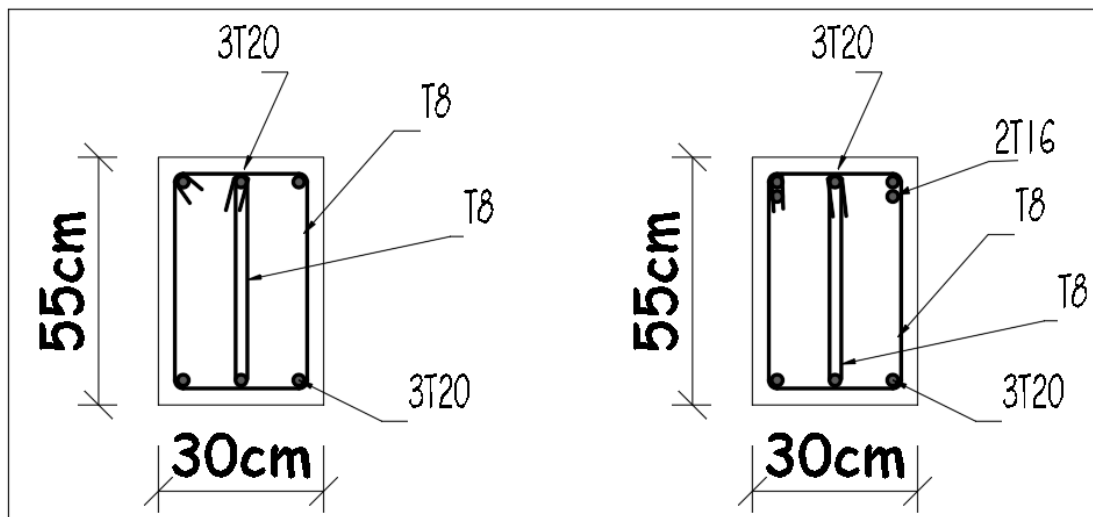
Ferraillage de la poutre secondaire 1er au 2ème
